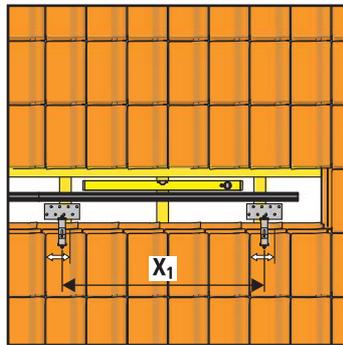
Determinazione della posizione di montaggio dei ganci da tetto
